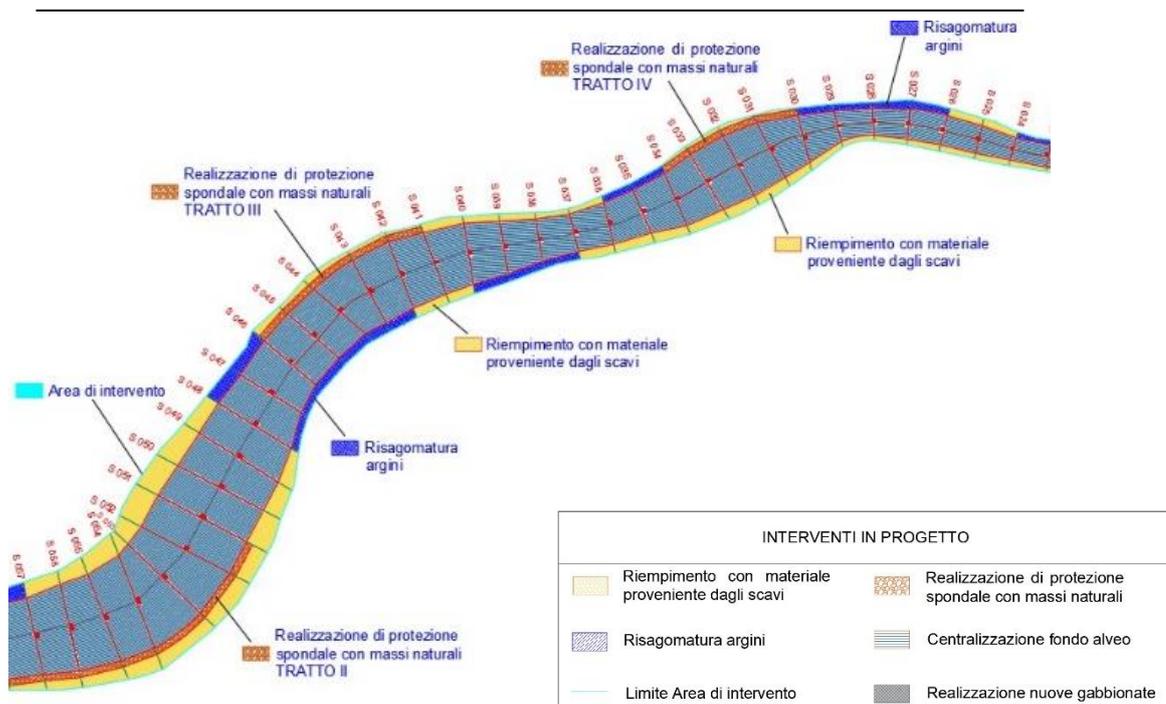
Fiume Lipuda – Planimetria con dettaglio 2 degli interventi di progetto
